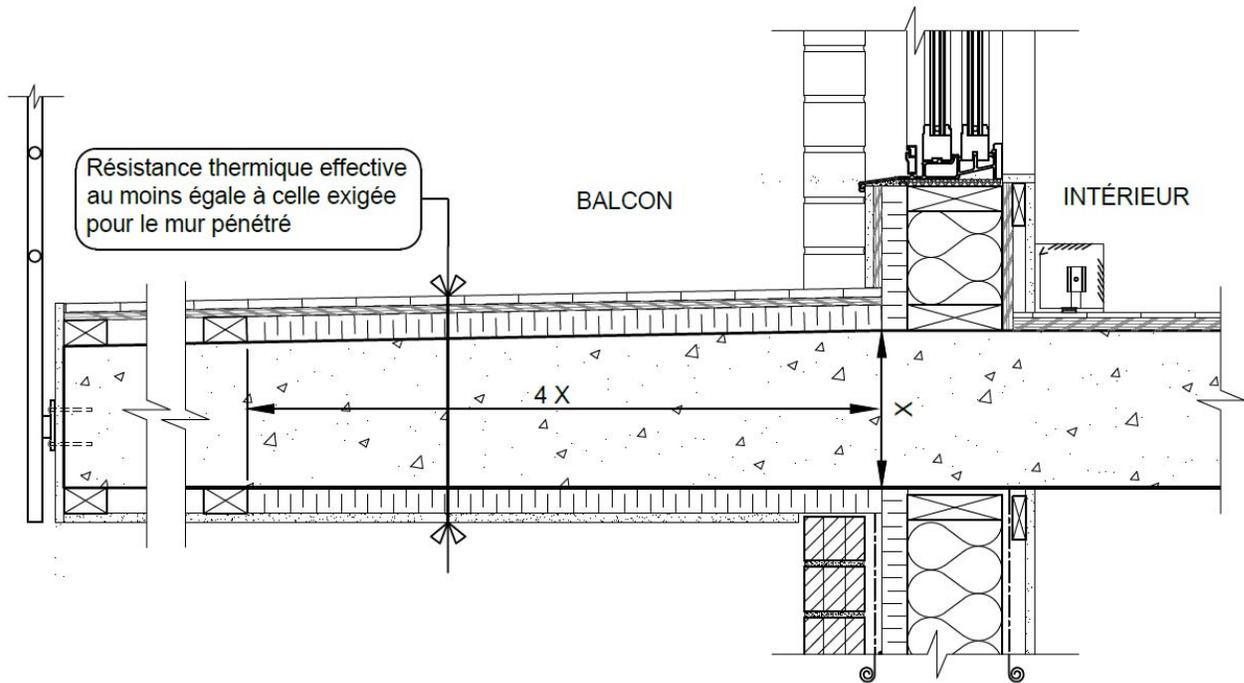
Continuité de l'isolation pour une dalle structurale en béton – Méthode c) (art.2.1.3.7c)
